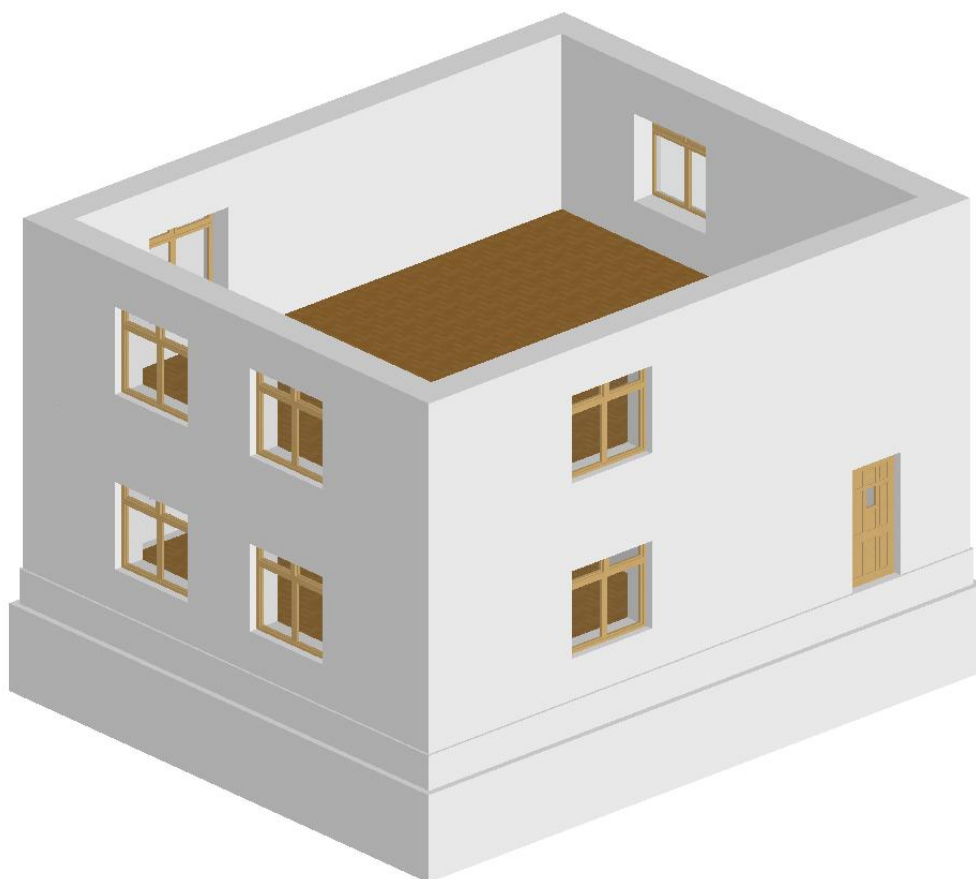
Общий вид 2-х этажного дома с цокольным этажом и фундаментом.
